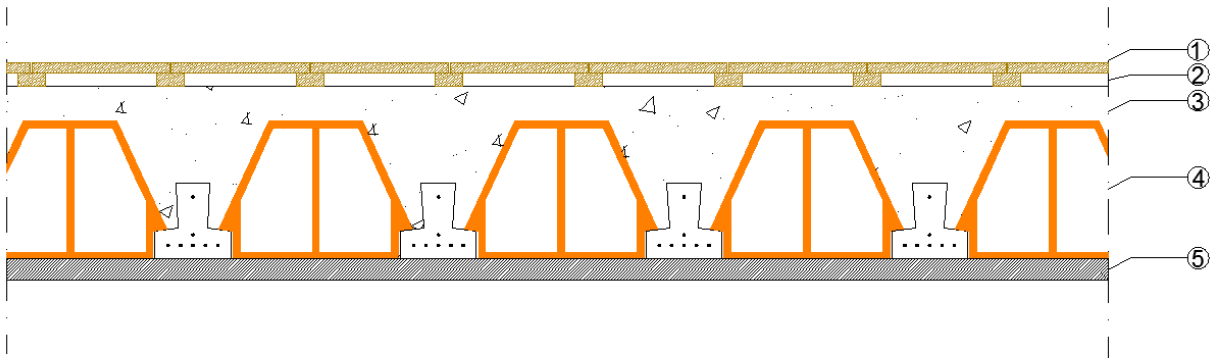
Pormenor construtivo da laje de rés-do-chão
